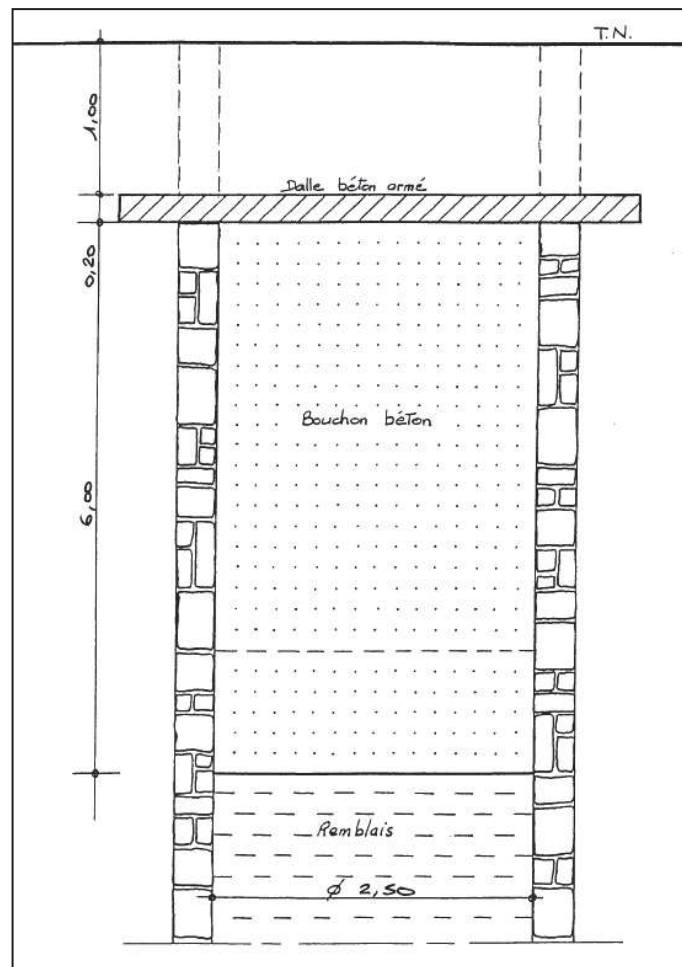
Schéma de mise en place du bouchon béton du puits Sud
